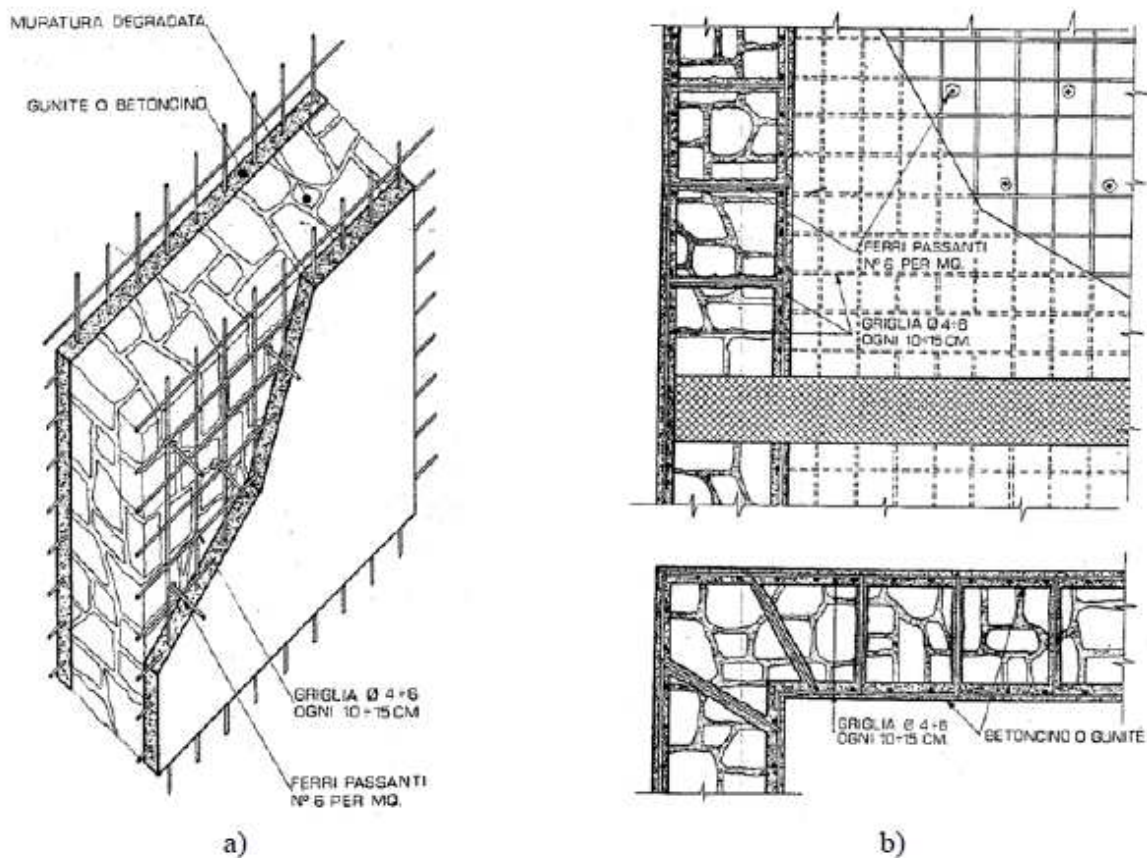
Consolidamento di muratura mediante lastre sottili (gunita o betoncino) armate con rete elettrosaldata in acciaio e collegate da ferri passanti; vista assonometrica (a) - sezione orizzontale e verticale (b)
